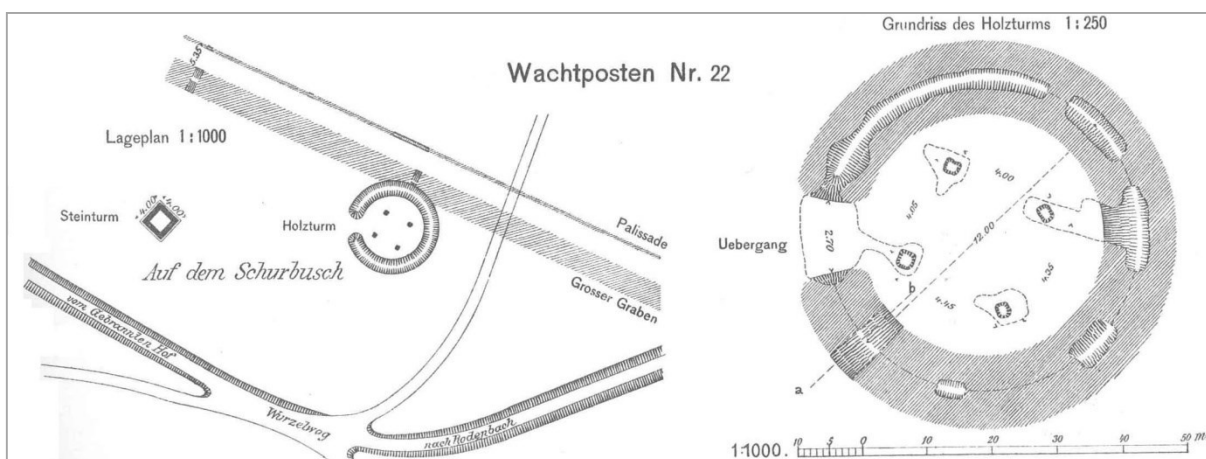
Lageplan und Grundriss des WP 1/22
